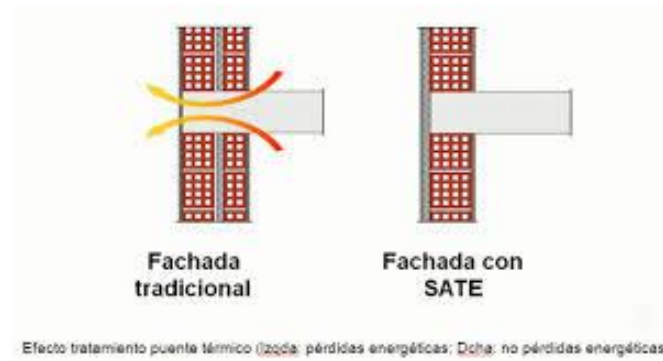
Muro SATE en fachada para eliminar puente térmico de frente de forjado.
